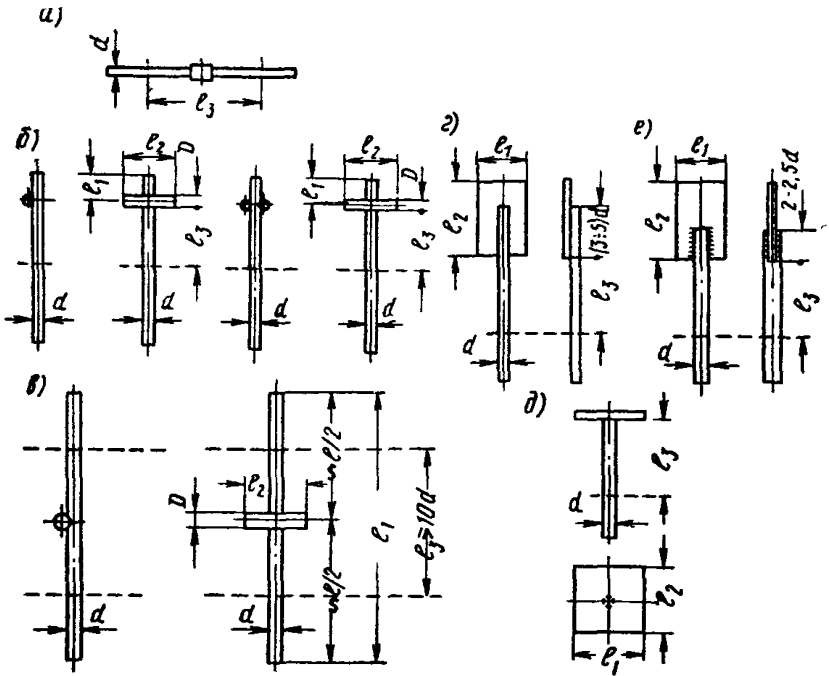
Конструкция и основные размеры пробных образцов сварных соединений для механических испытаний
